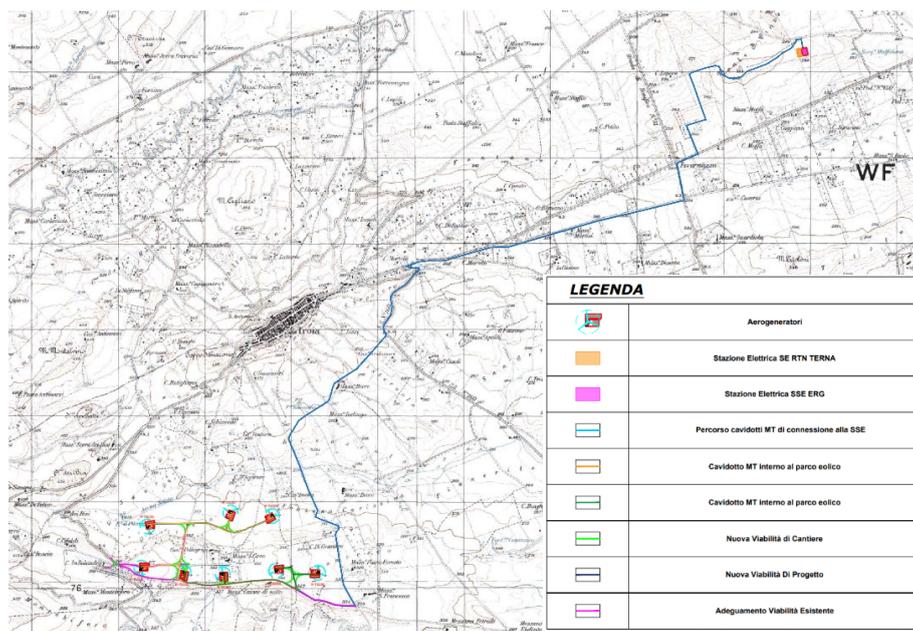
LAYOUT IMPIANTO SU IGM
